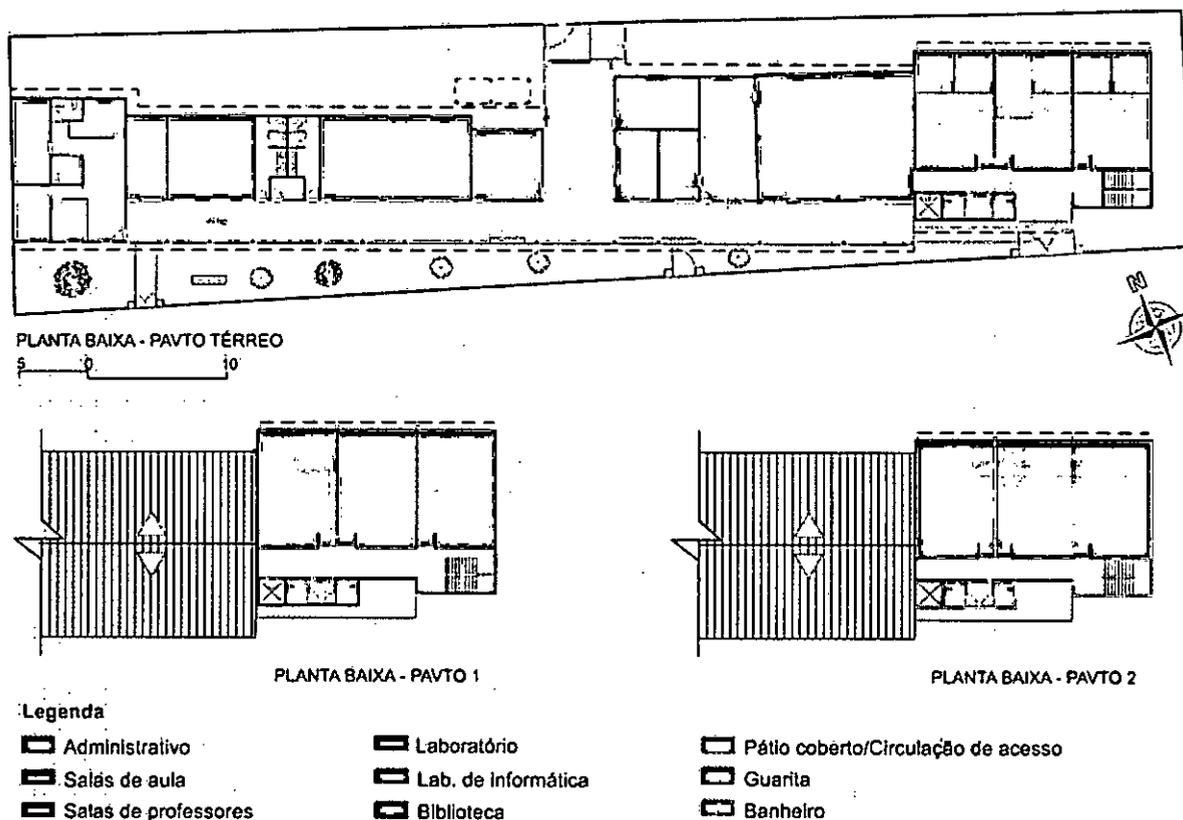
Setorização da Sede da Unidade Penedo. Elaboração: Equipe Técnica do Plano Diretor
